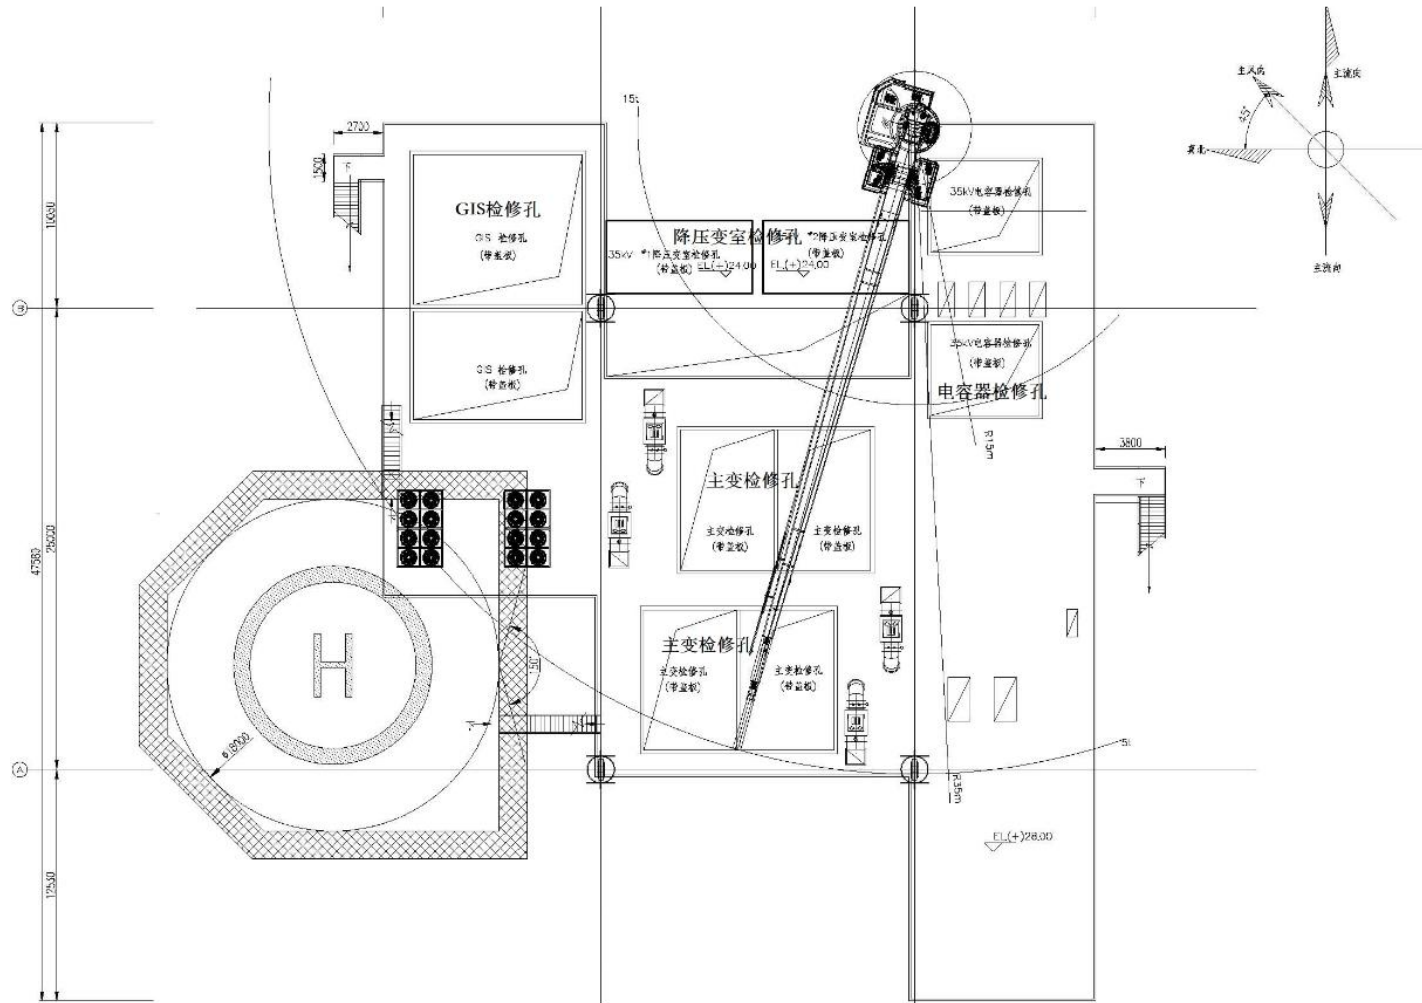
CFD11-1EPP 平台上层甲板平面布置图
